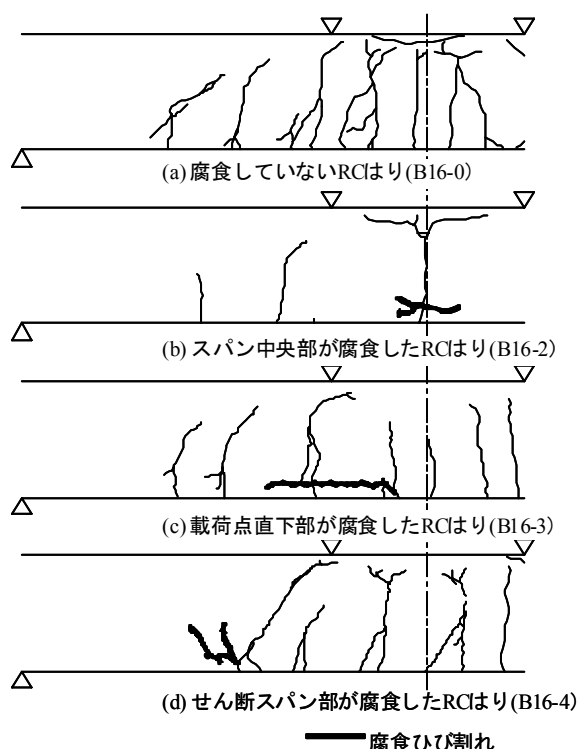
最大荷重時のひび割れ状況 (B16シリーズ)
